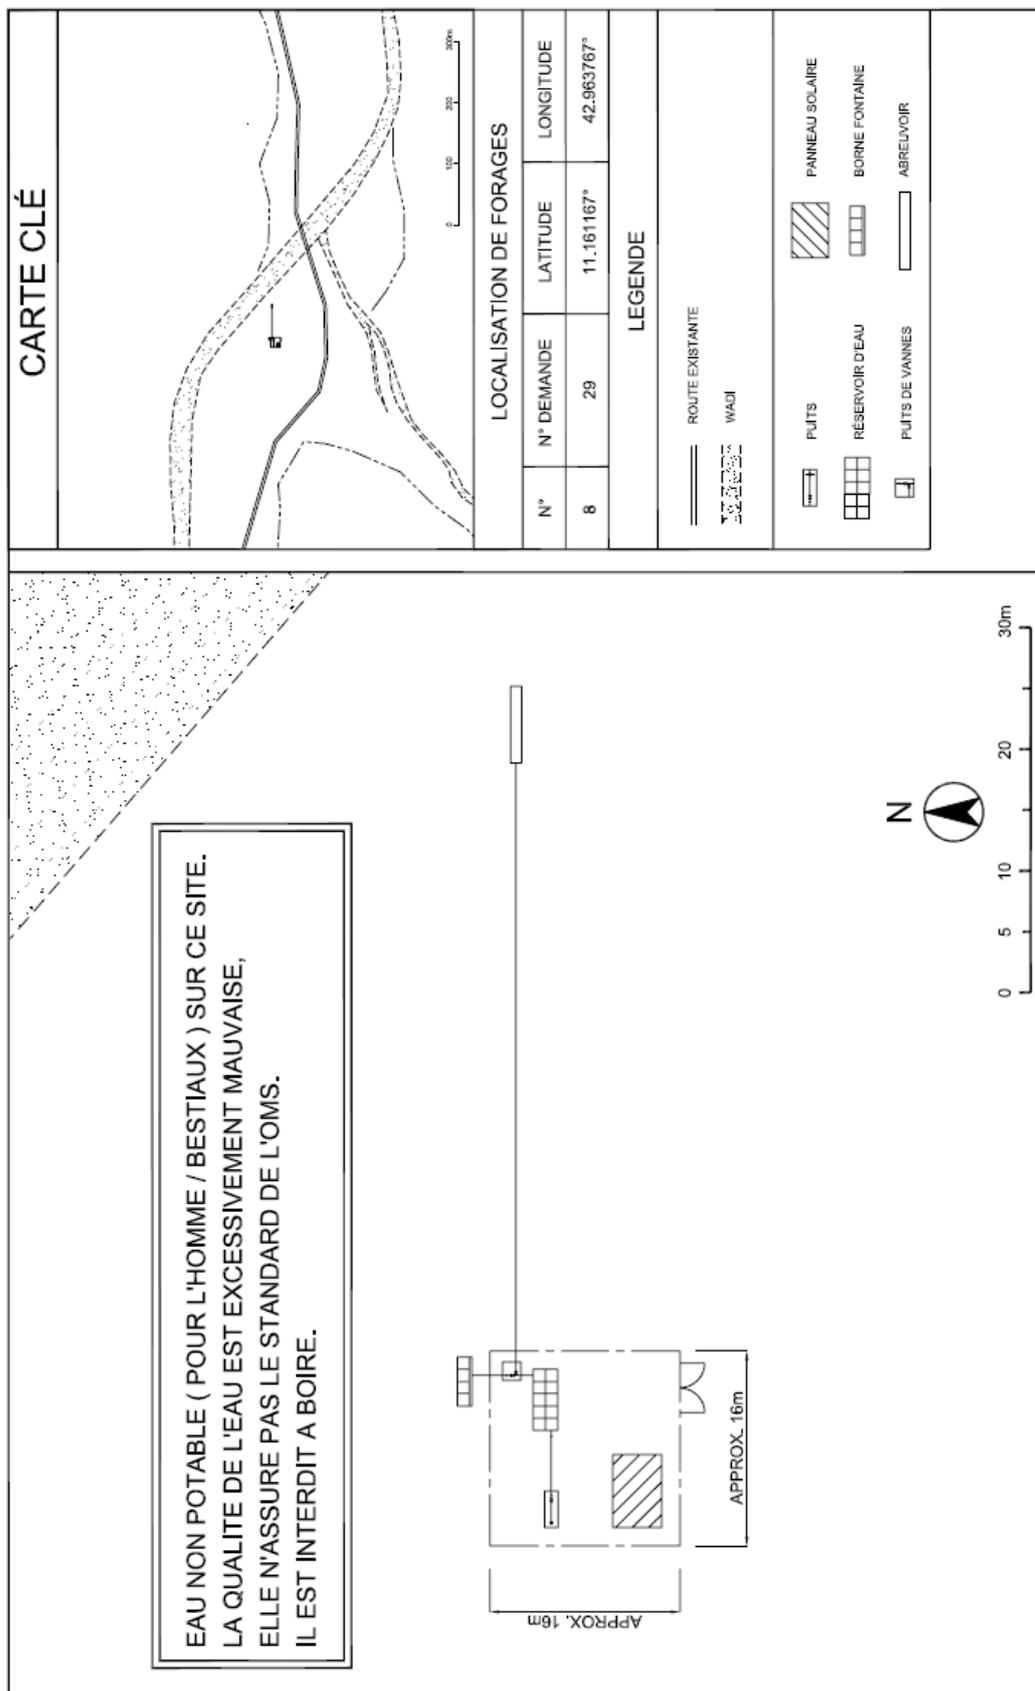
Plan d'implantation des installations (ix) [Midgarra]
